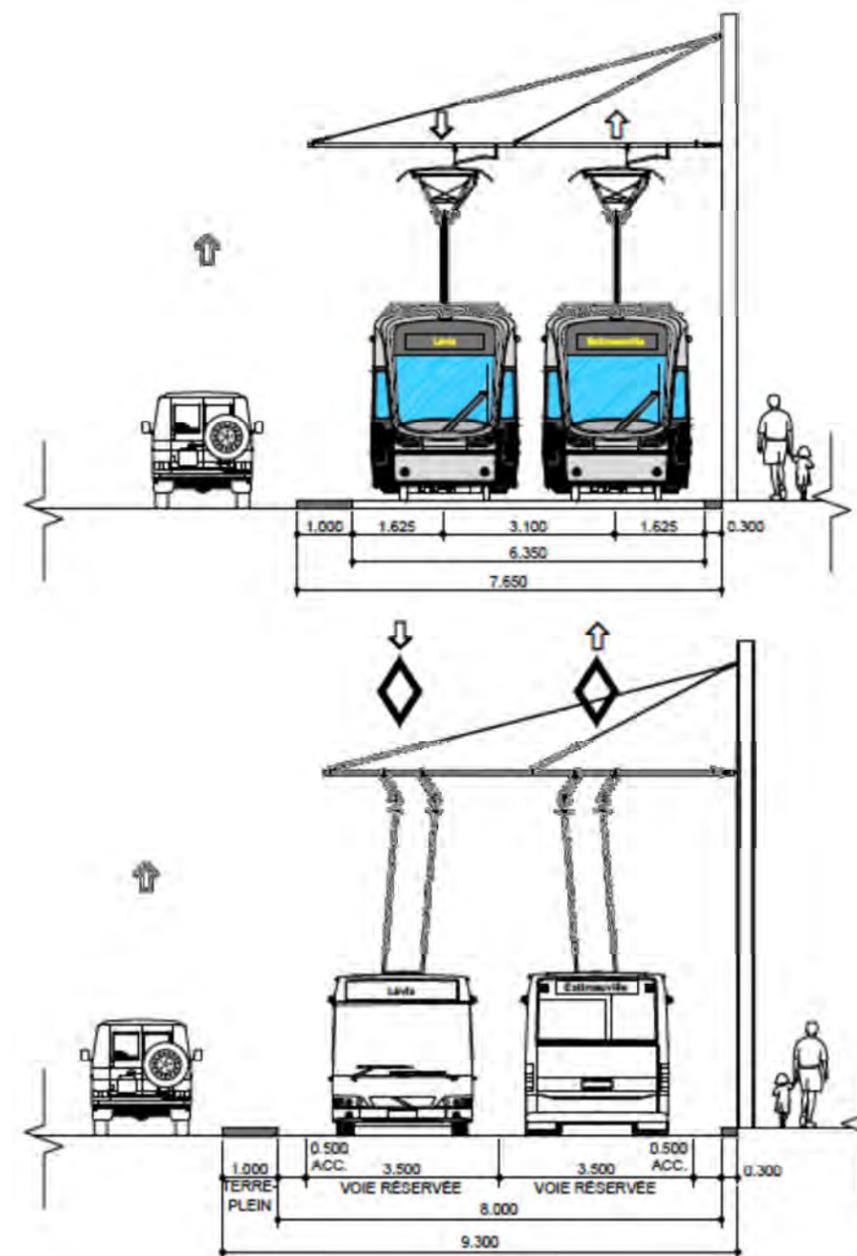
Coupe type 12 de 15 - SRB - Site propre standard - Insertion latérale
